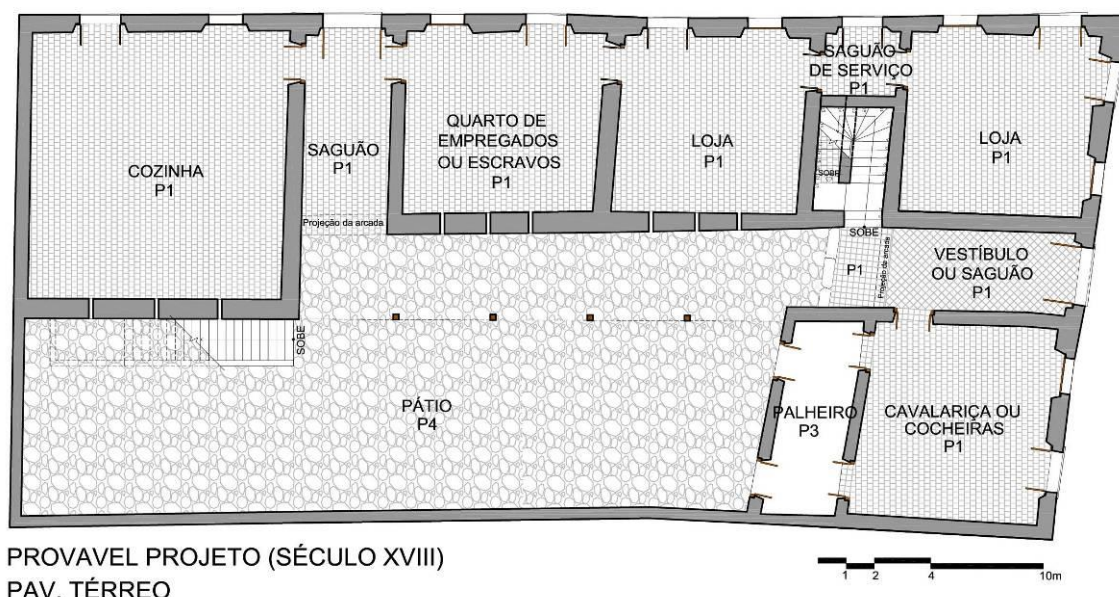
Planta baixa do pavimento térreo da Casa Rosada. Provável projeto (século XVIII).
